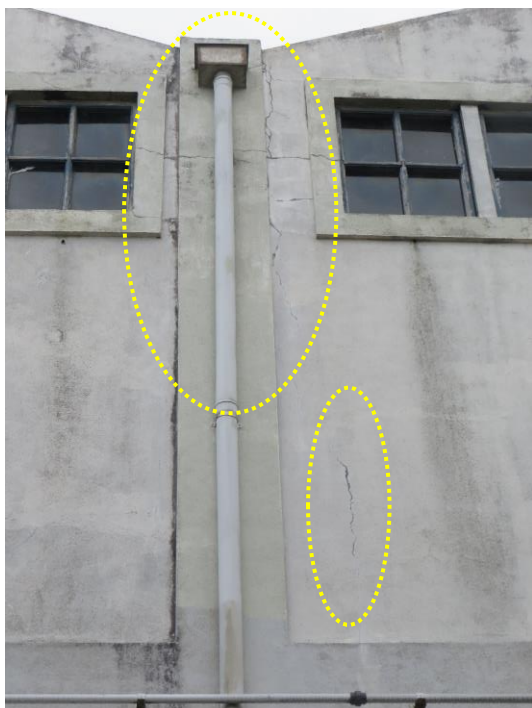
Fissuração na fachada Sul junto a pilar e adjacente a junta de dilatação (à direita).
